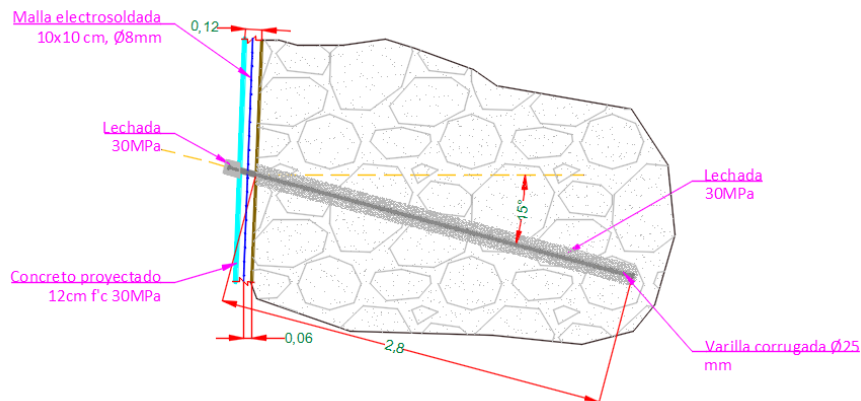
Detalle bulón en sistema Muro-Estribo, vista lateral
